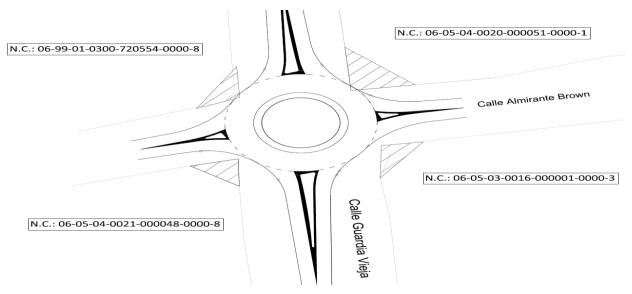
Proyecto Rotonda Calle Guardia Vieja y Almirante Brown, Vistalba
